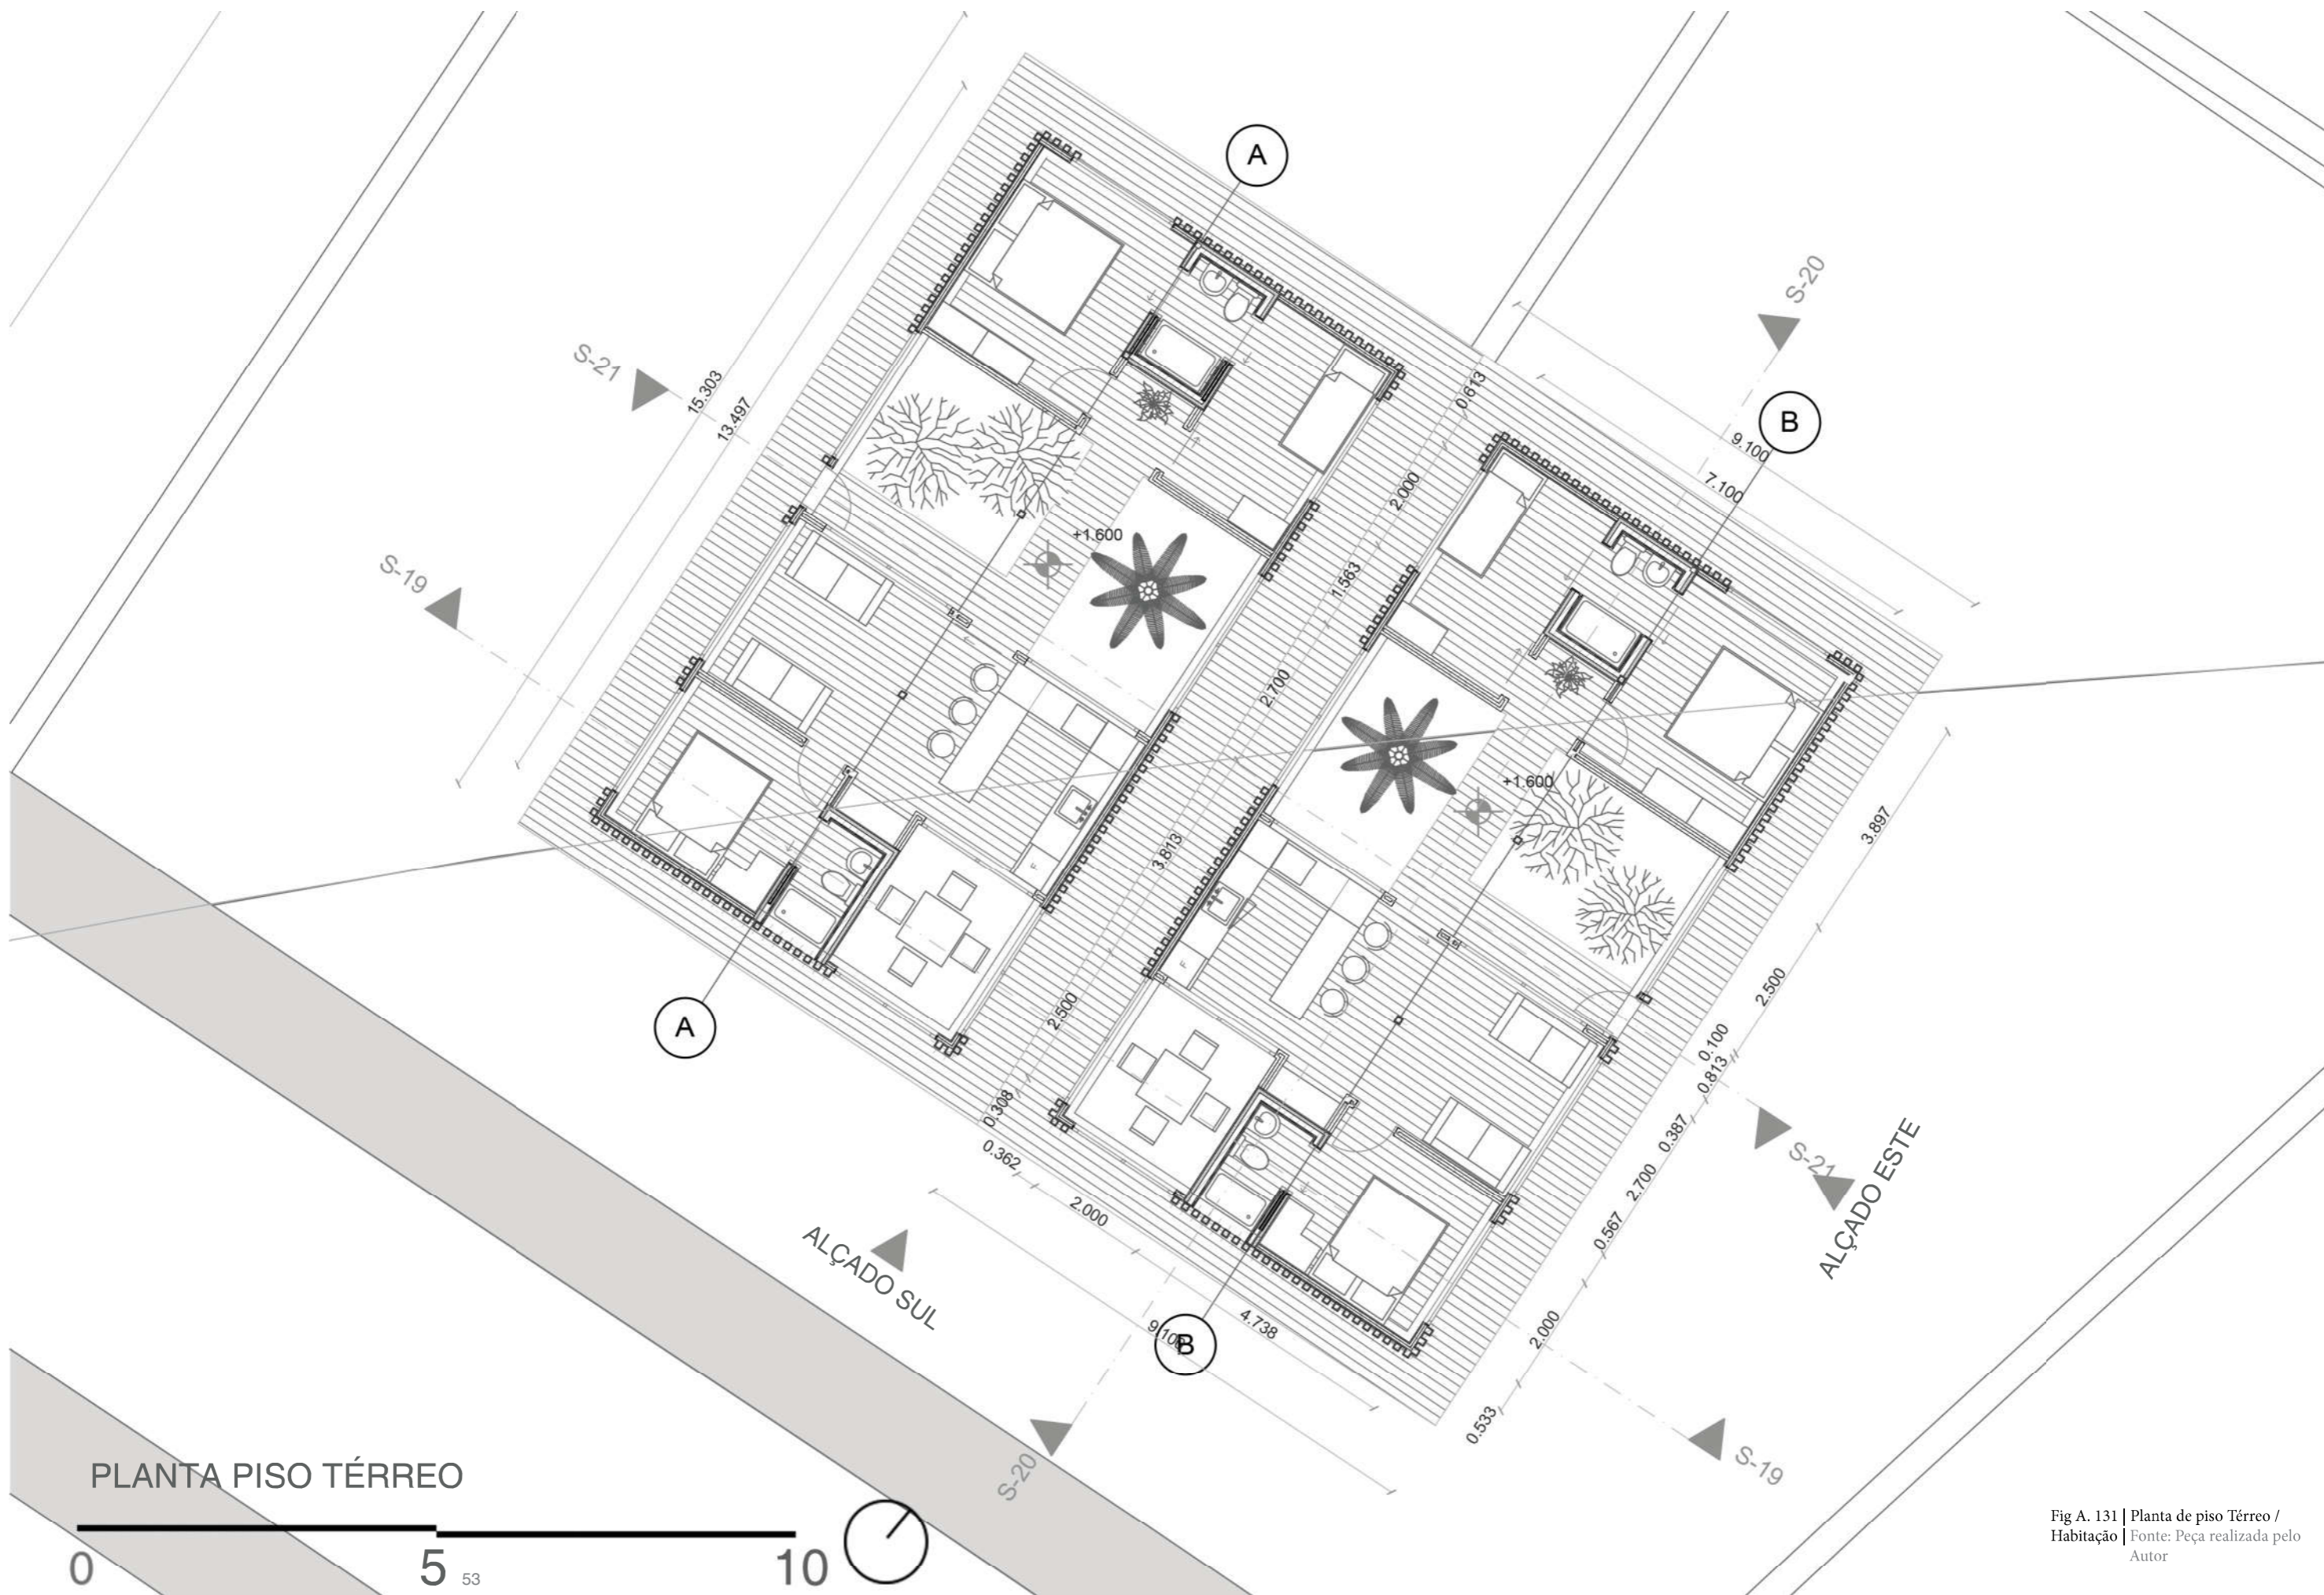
| Planta de piso Térreo / Habitação | Fonte: Peça realizada pelo Autor
